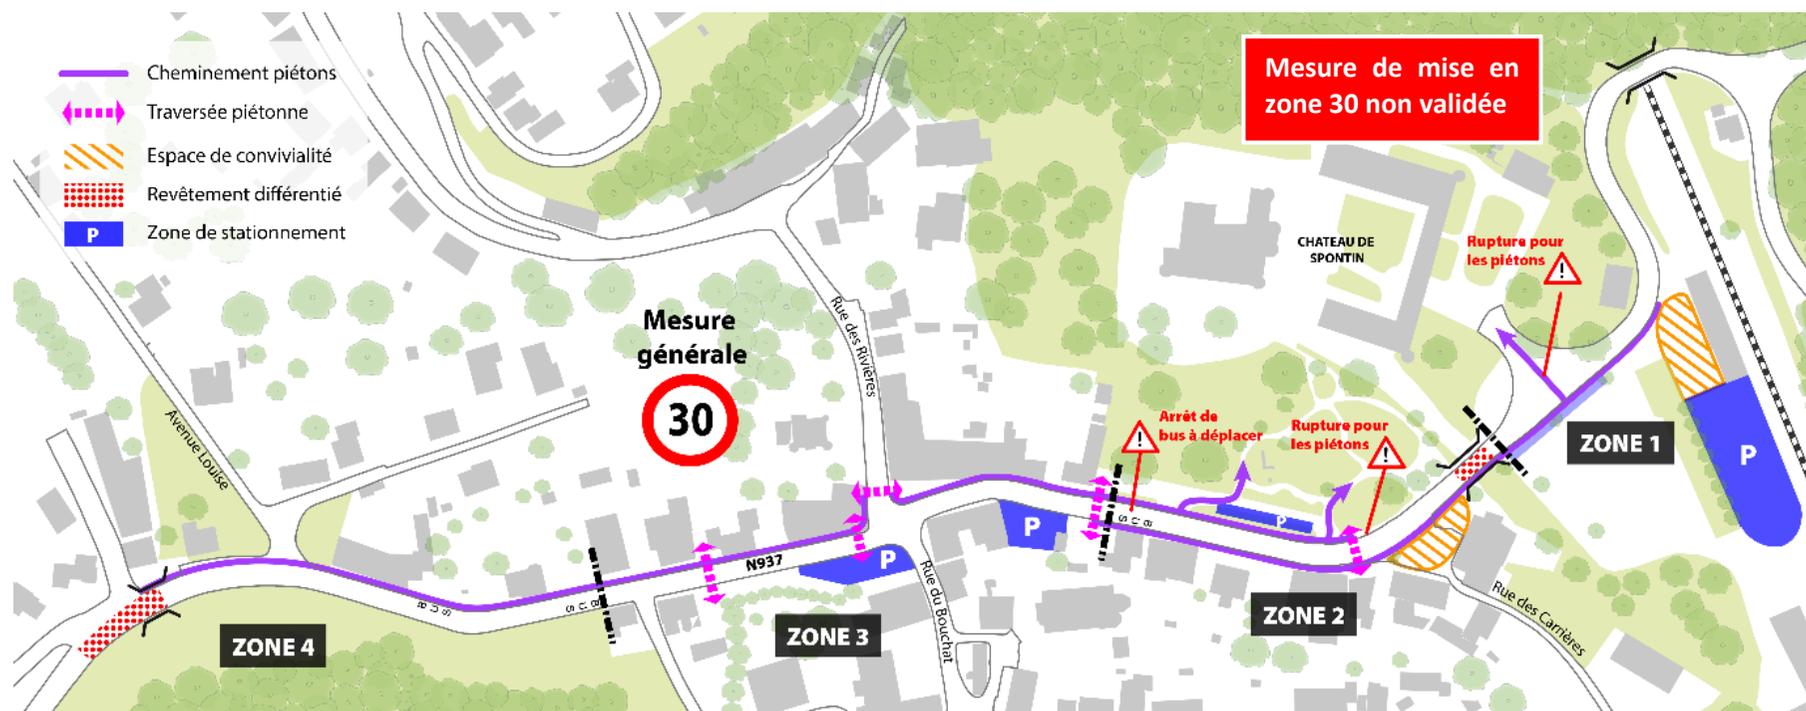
Propositions d'aménagement de la traversée de Spontin – plan global
